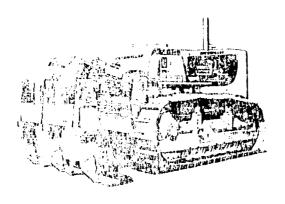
C EQUIPO DE DESGARRAMIENTO INSTALADO EN TRACTOR.
